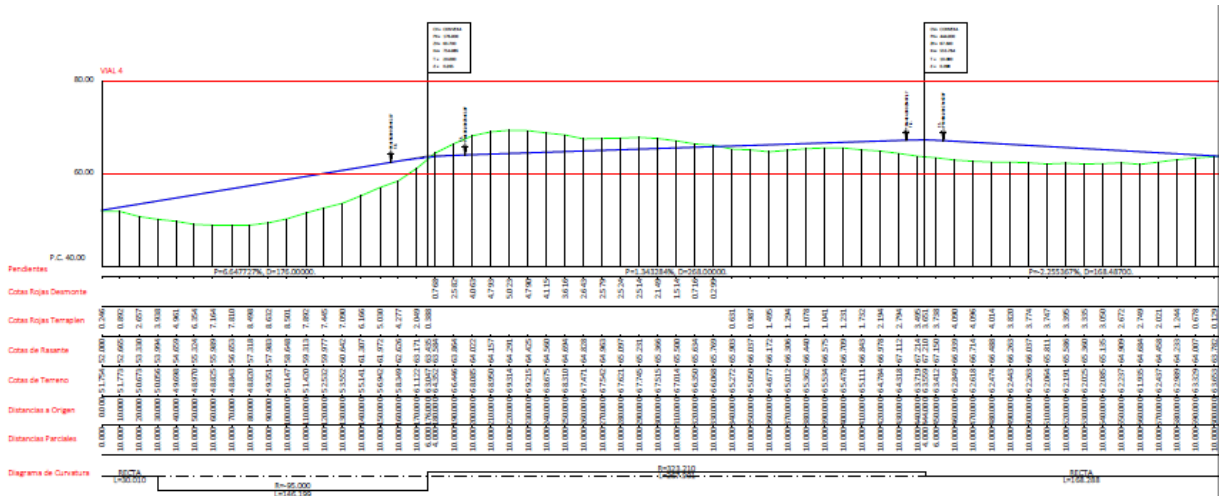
Imagen de la sección longitudinal del vial 4 en la alternativa 2.
